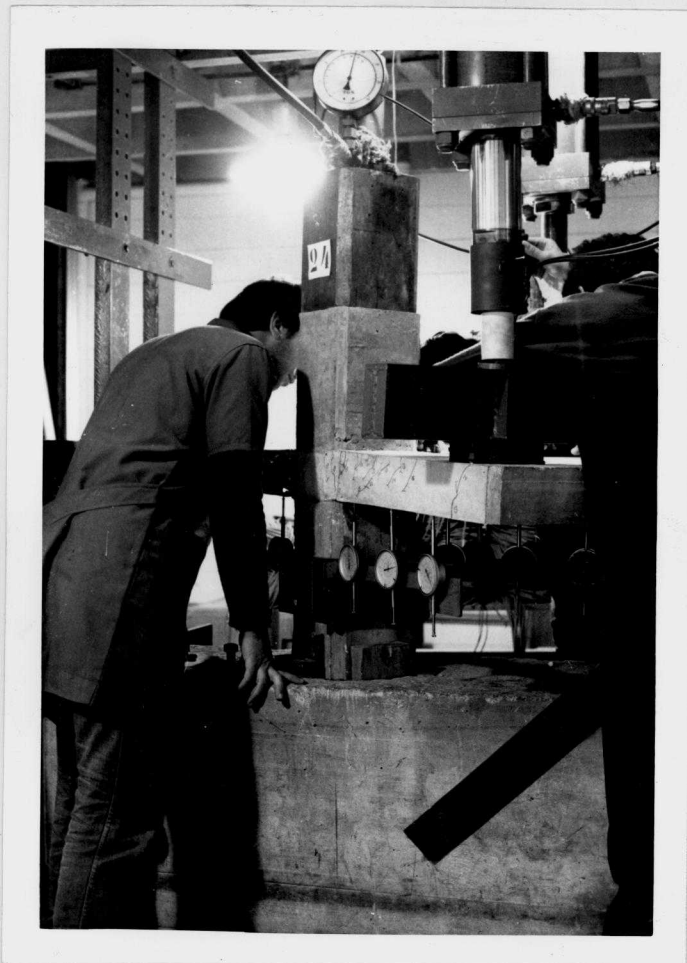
Ensaio do "elemento de laje" 24.
